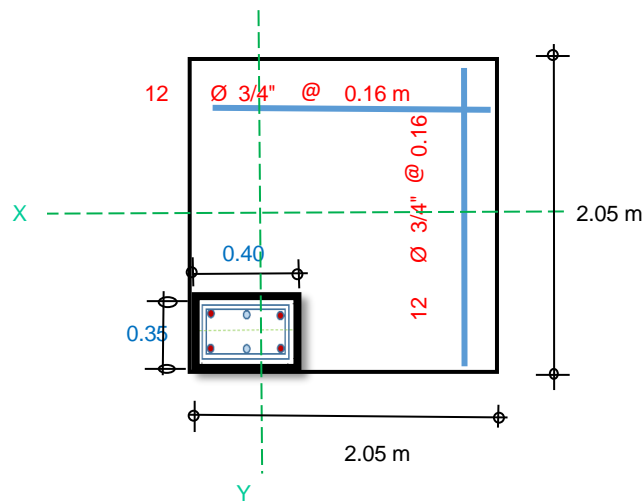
Detalle de planta de zapata esquinada (Estructura 2).
